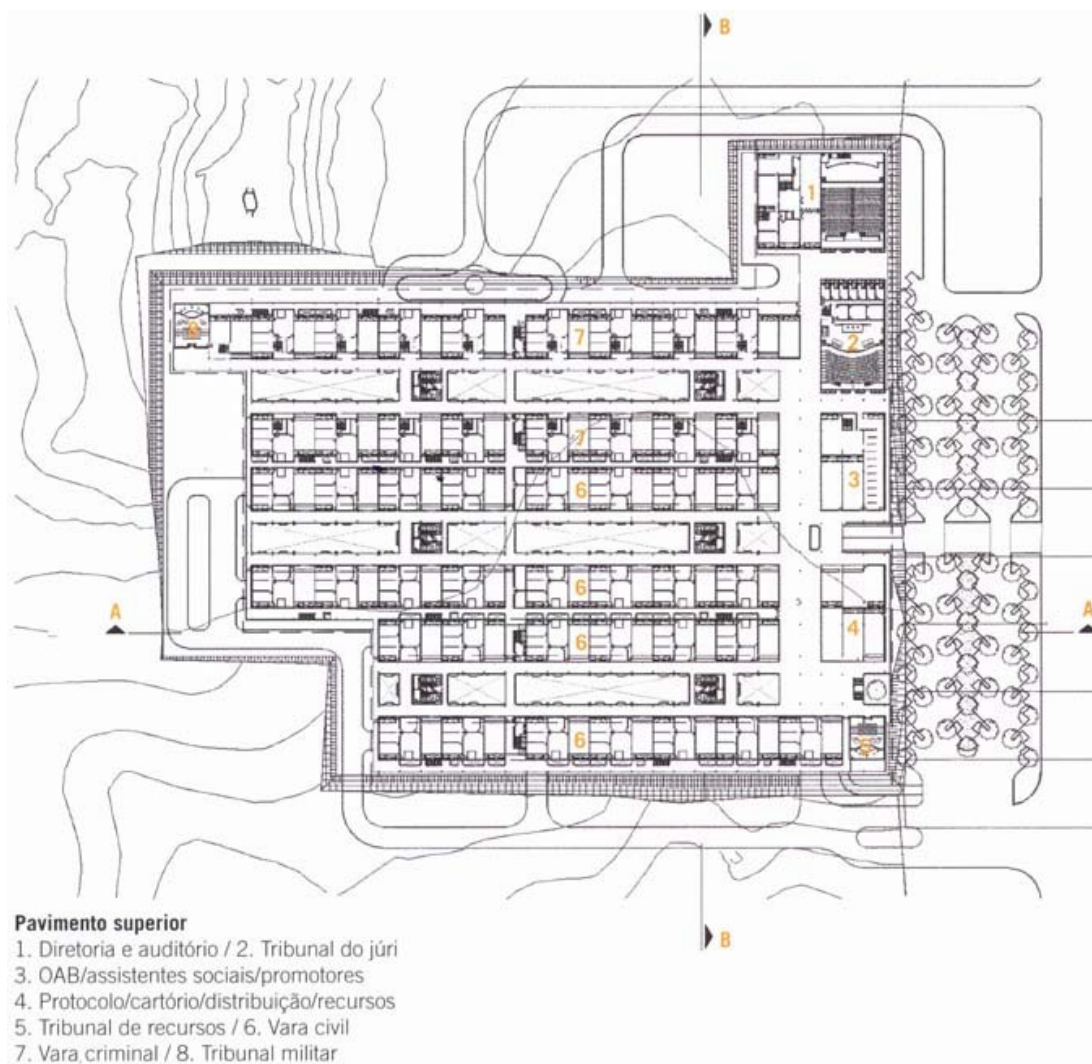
Planta do Pavimento Superior (Fonte: Marcelo Suzuki)
